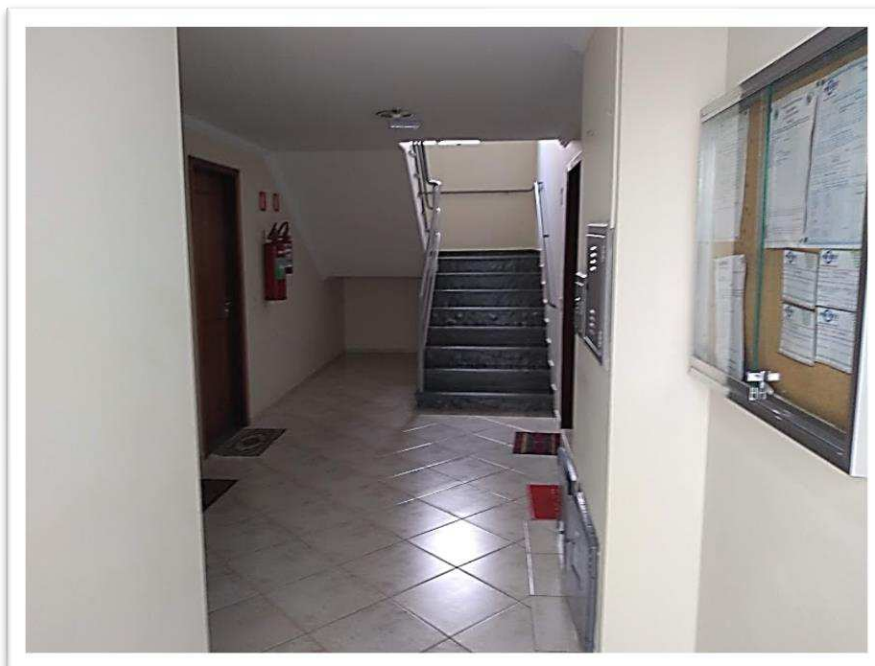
Aspectos do hall de entrada no pavimento térreo.
